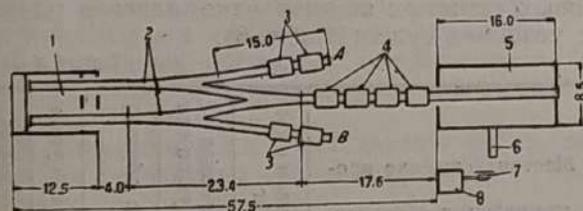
Схема расположения топливного цеха газогенераторной базы:
